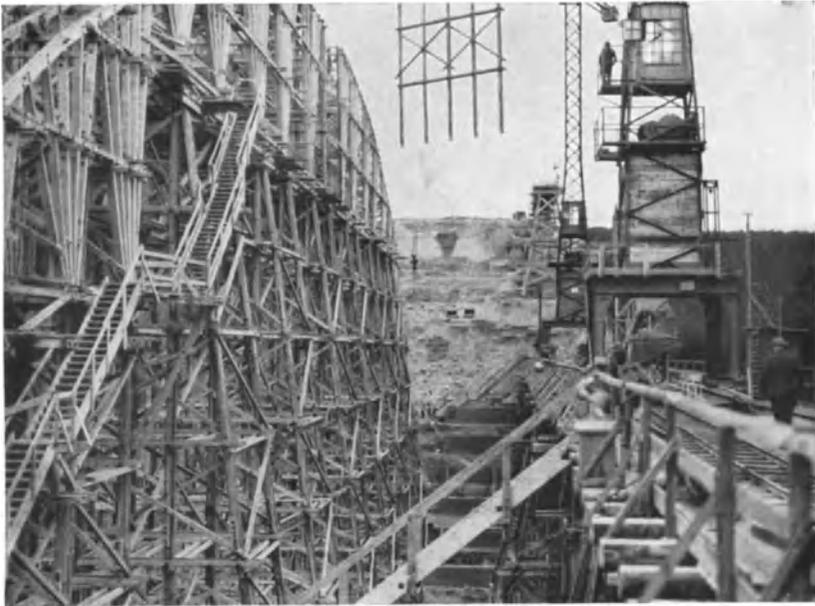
Das Lehrgerüst im Bau. (Turmdrehkrane von 28 m Nutzhöhe und 20 m Ausladung.)
